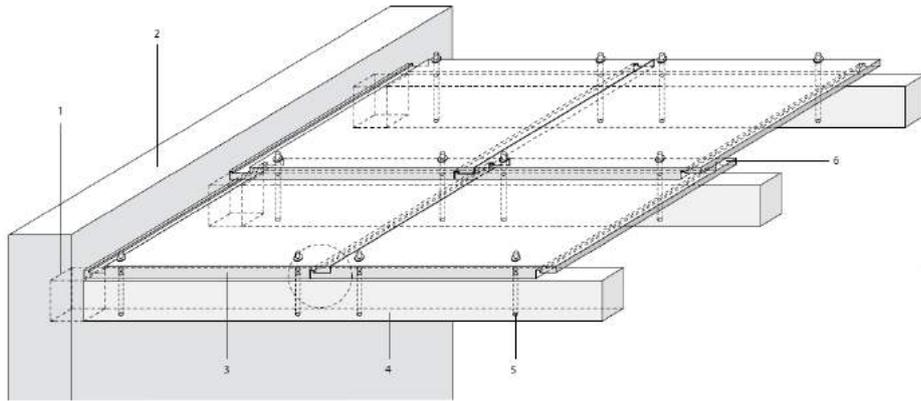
Pormenor dos painéis modelares 1 parede de rolamentos 2 painéis de telhado 3 subestrutura de madeira 4 parafusos 5 sobreposição de painéis de telhado
